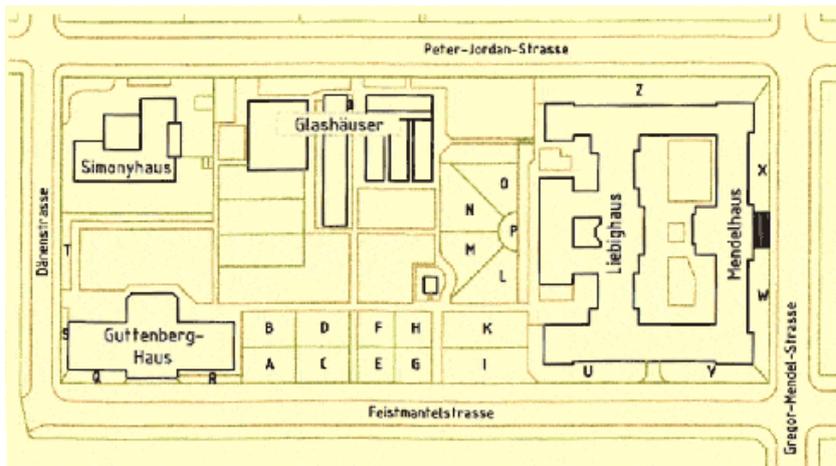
Situationsplan der Gebäude und Flächen, ca. 1970.
